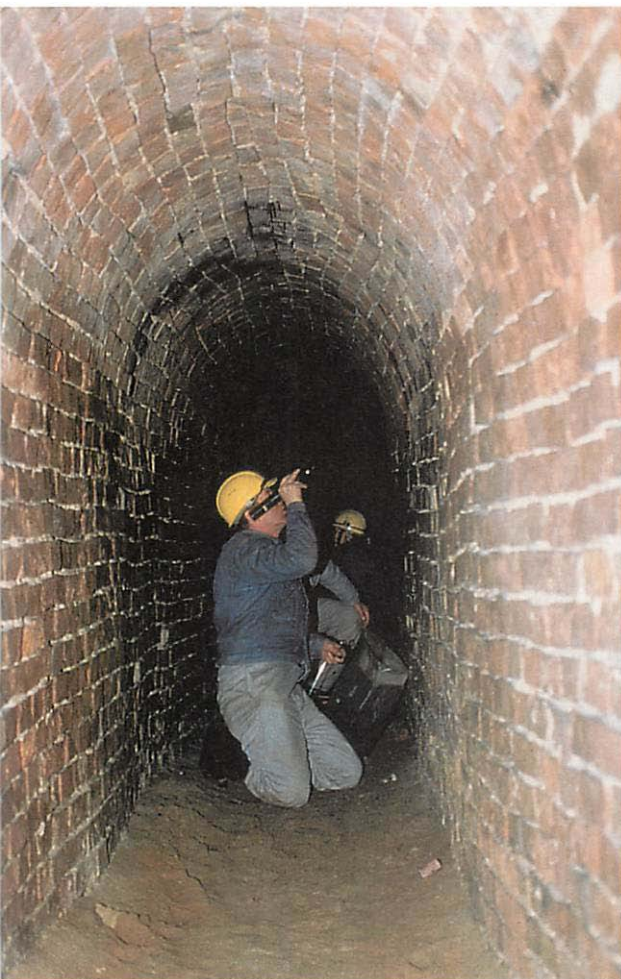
Blick in den ausgemauerten, spaltenreichen Alauntunnel - beschwerliche Fledermaussuche.
